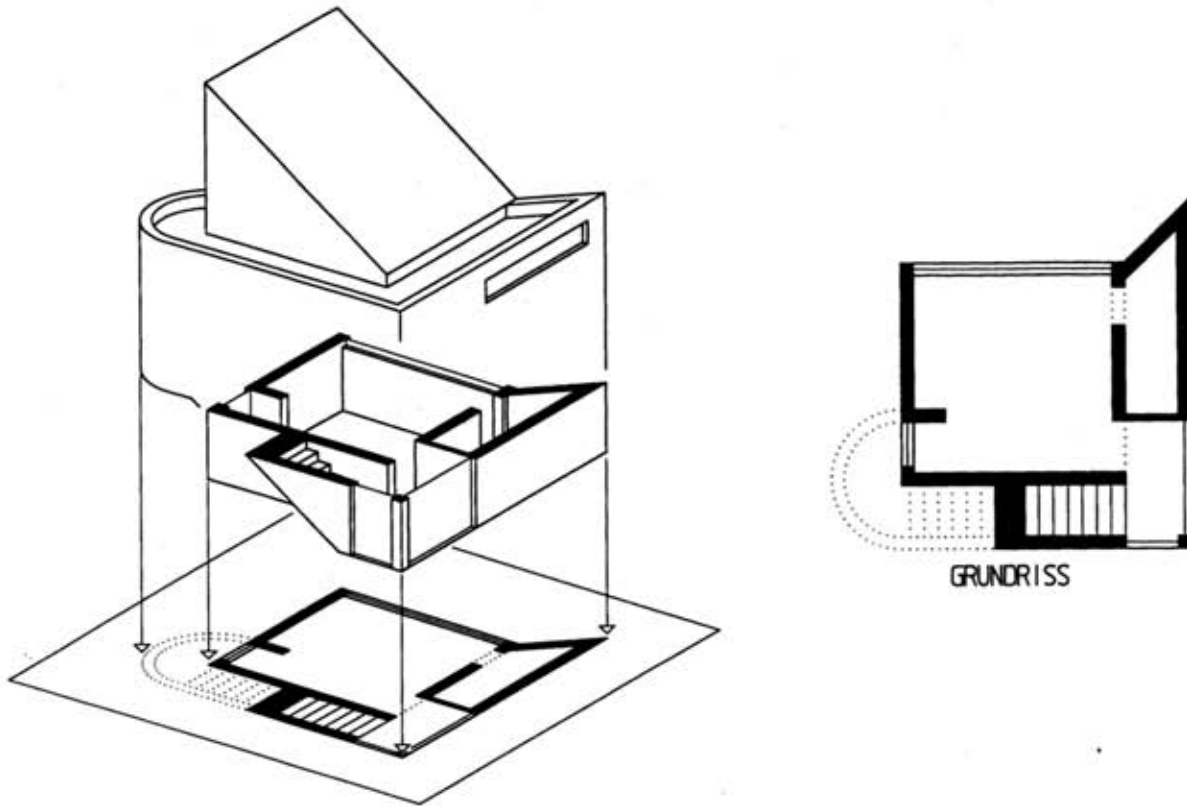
Grundriß Typ A (Abbildungsprinzip)
